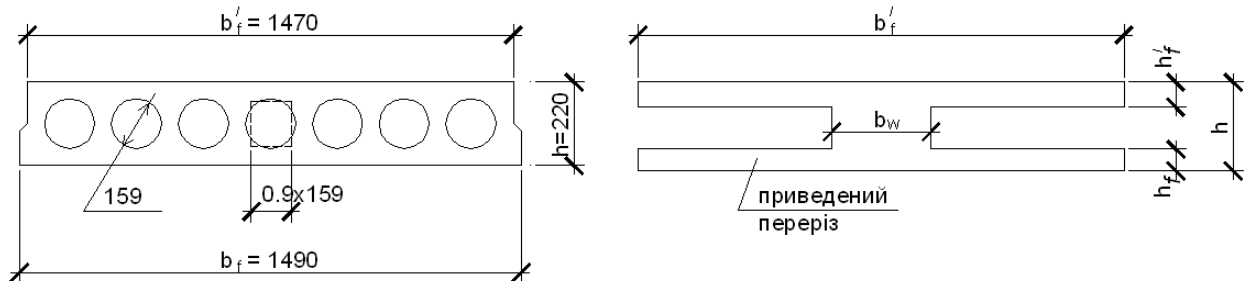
Фактичний та приведений переріз плити з круглими порожнинами шириною 1,5 м
